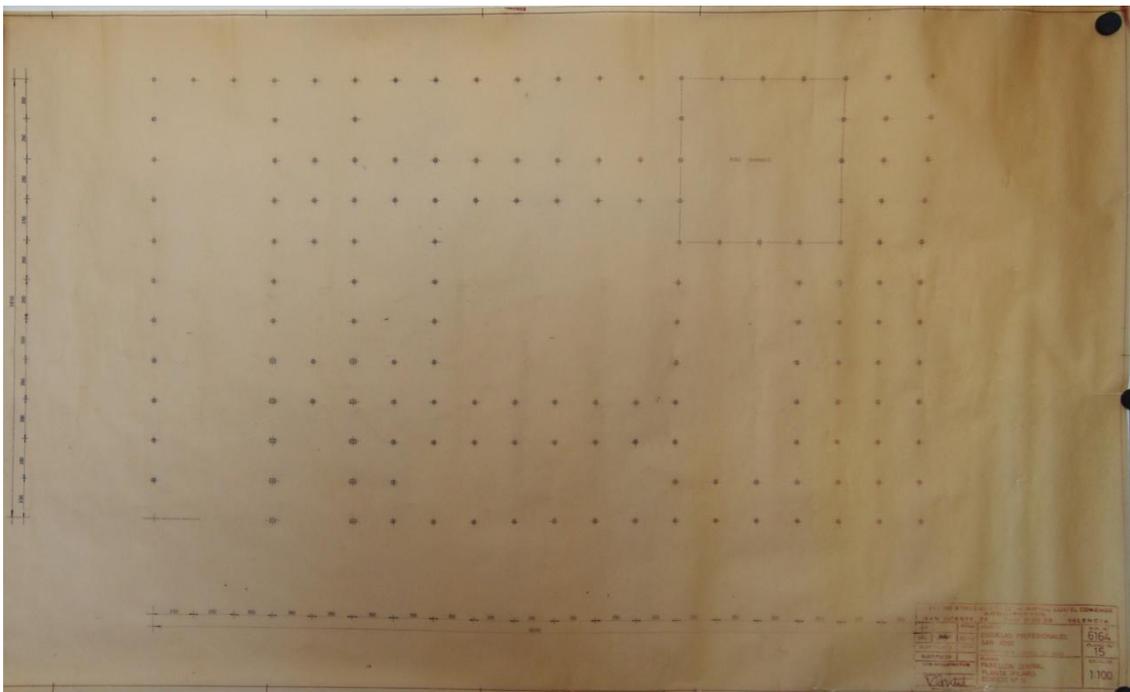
Plano de pilares edificio central. *Archivo Escuelas San José.
